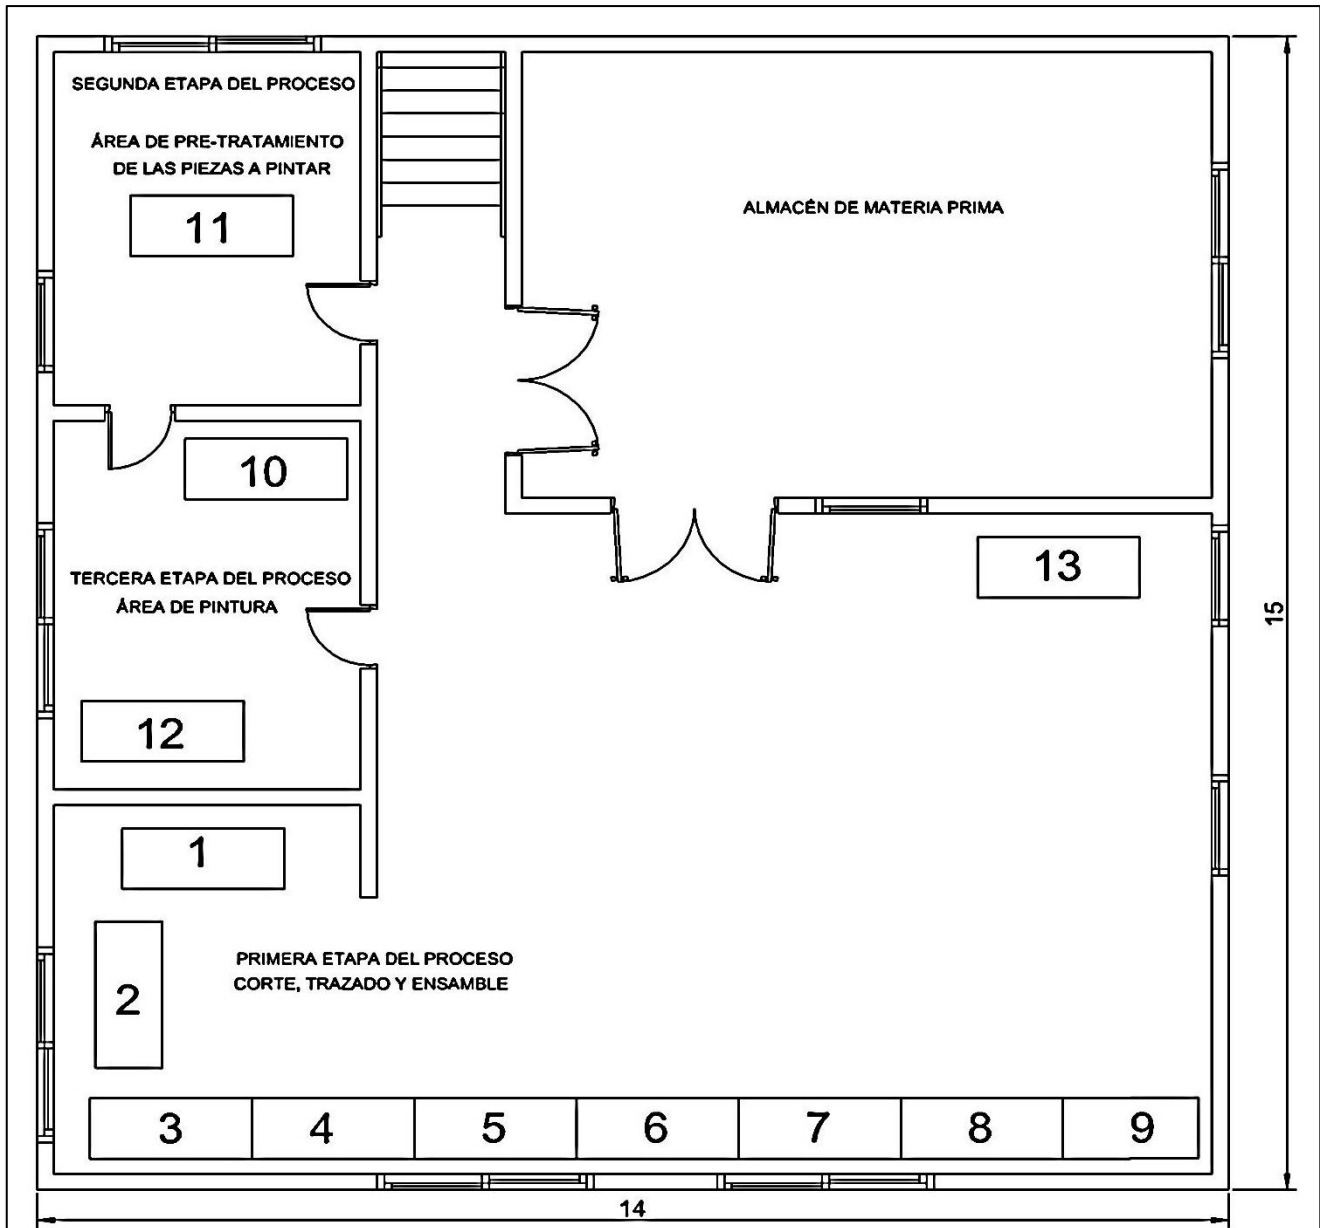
Plano: Planta Alta de las instalaciones de la empresa. Fuente: Rondón (2018)
